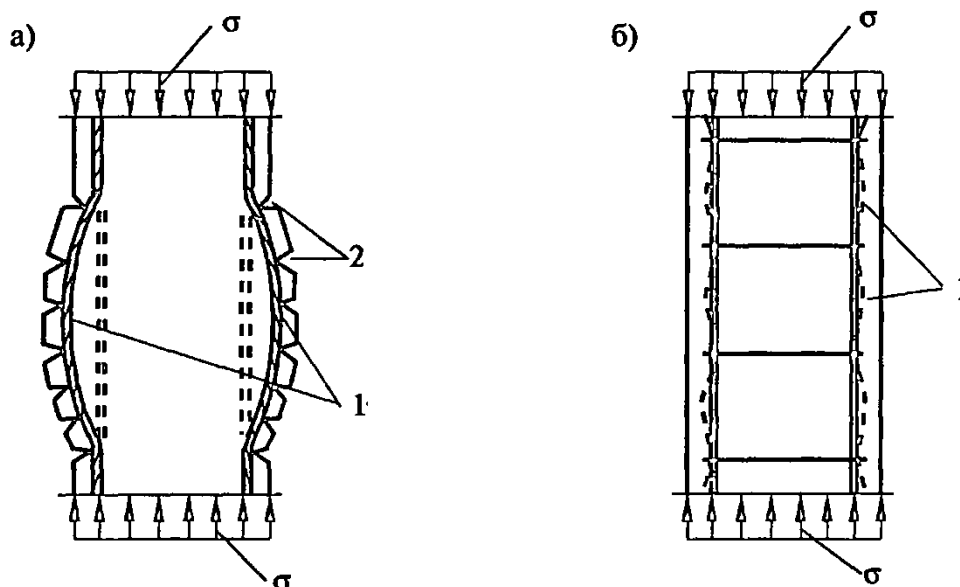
Потеря устойчивости арматуры в сжатом железобетонном элементе:
